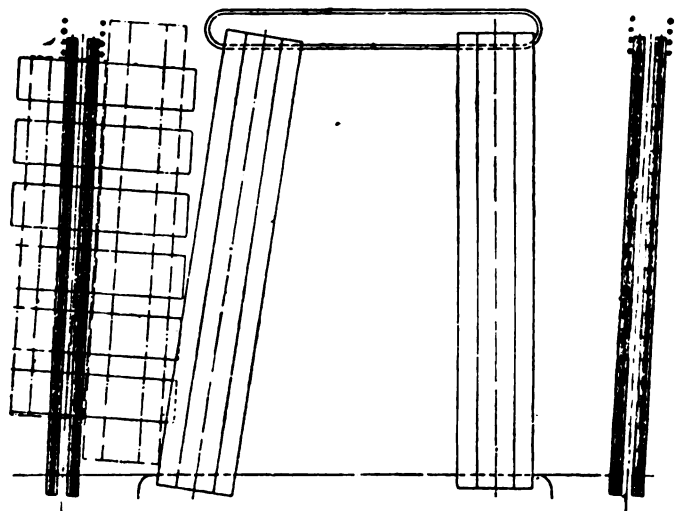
Gru per la sostituzione del ponte - Disposizione planimetrica.
